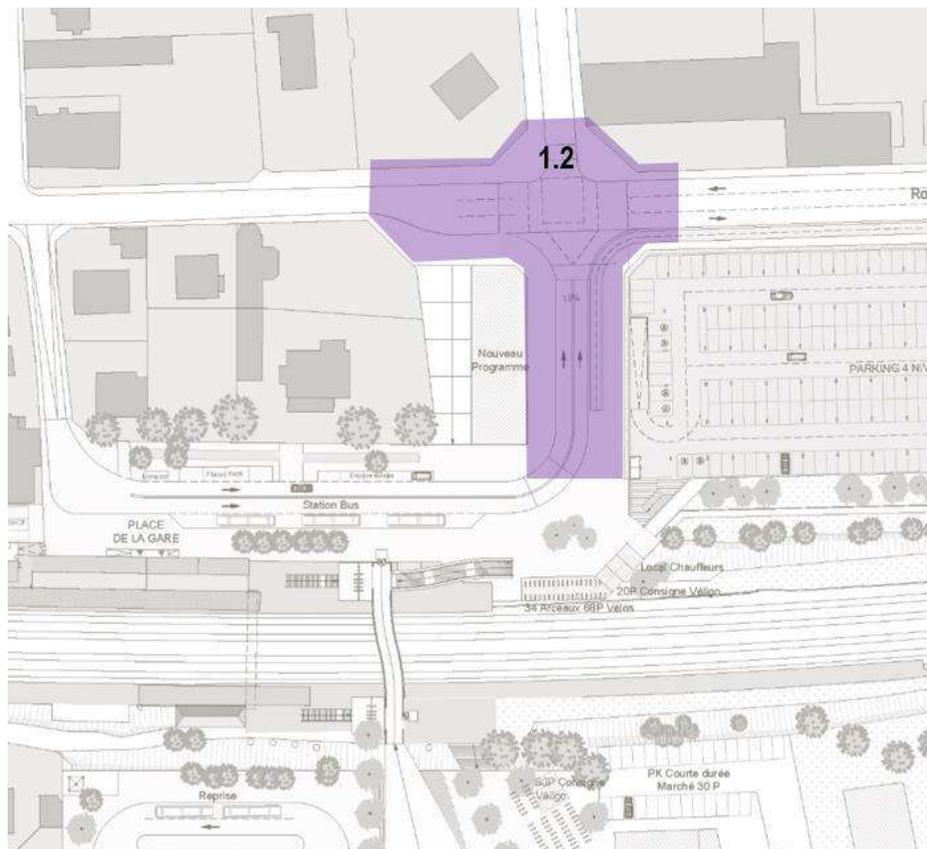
Carrefour RD 25 / RD 35 / Suppression giratoire / rampe parking
